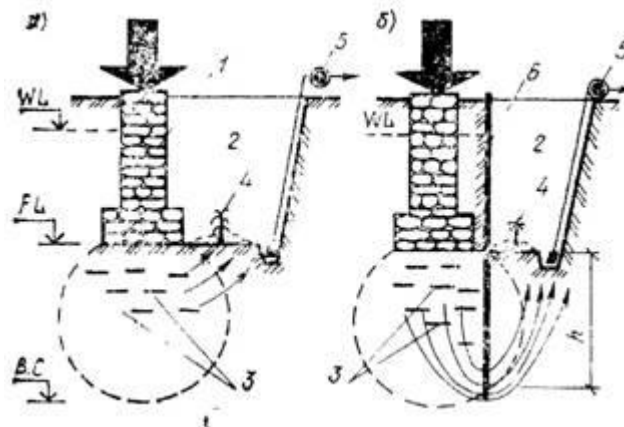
Суфозійне руйнування ґрунту під існуючими фундаментами при відкритому водовідливі: а - без огорожуючого шпунта; б - при шпунті, що не забитий до водоупора або недостатньо заглибленому нижче дна котловану; 1 - існуючий фундамент; 2 - котлован споруджуваного будинку; 3 - області можливого утворення пустот; 4 - грифони; 5 - насос; 6 - шпунт; h - глибина занурення шпунта нижче позначки дна котловану
